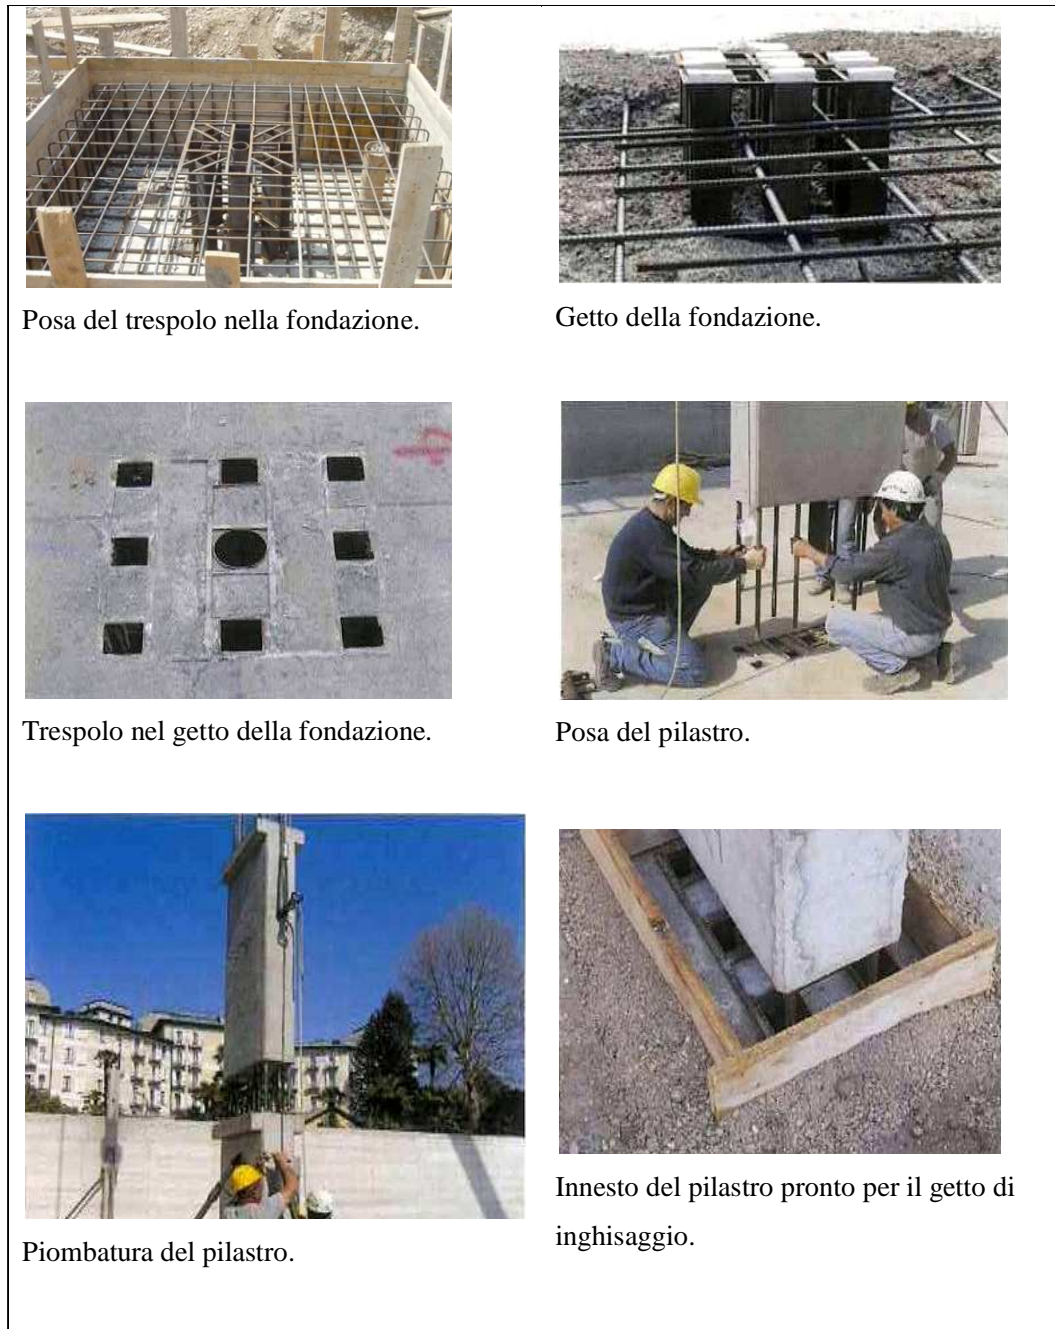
Fasi del montaggio del pilastro nella fondazione.
